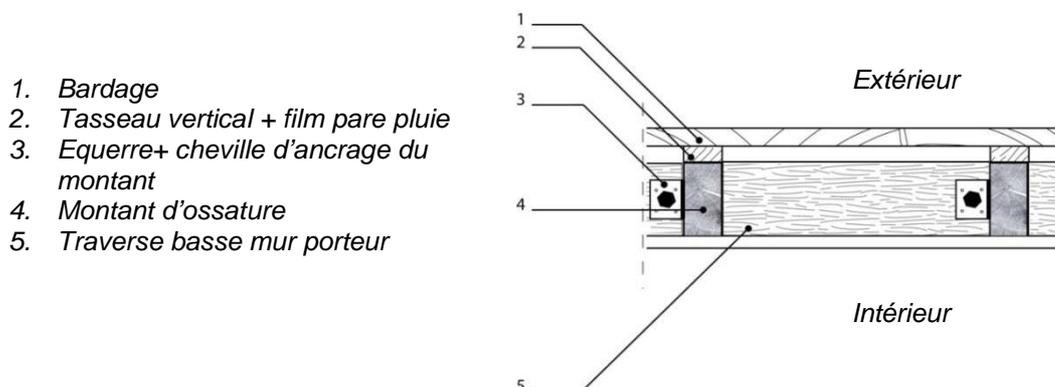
Coupe horizontale sur montants d'un panneau courant secondaire avec équerres d'assemblage
